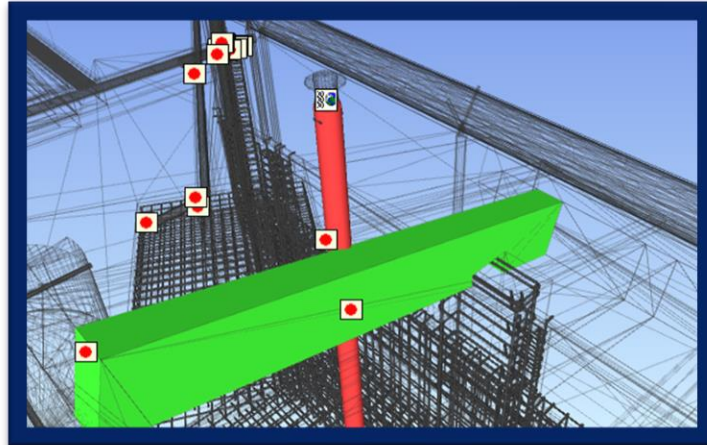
Tubería de ventilación interfiriendo en vigueta de techo aligerado.
